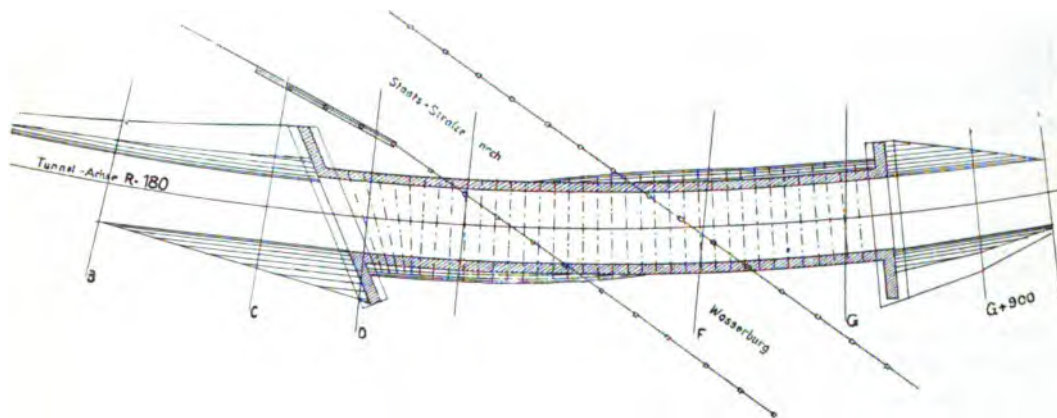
Grundriß des Betontunnels bei Wasserburg.
